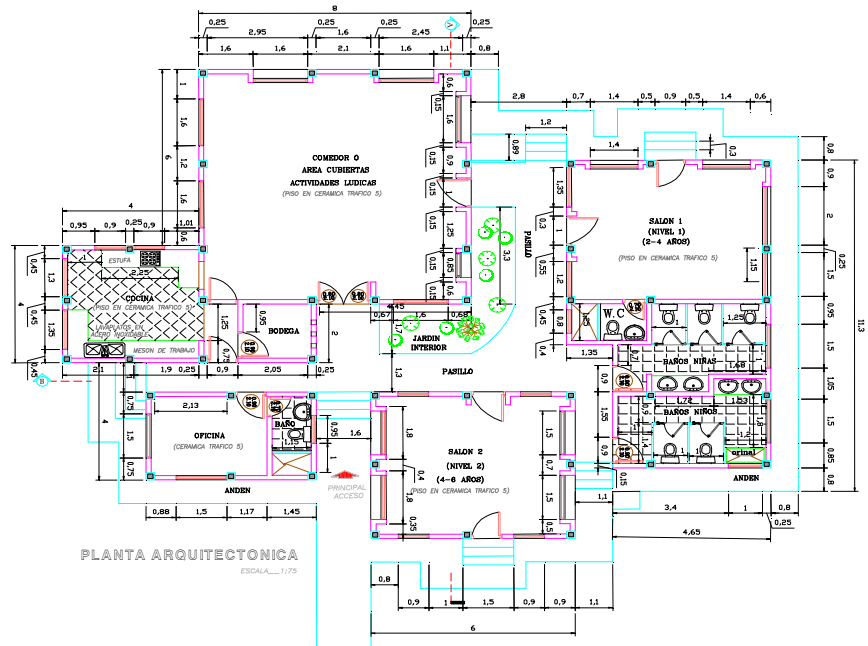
Planta Arquitectónica, Hogar Infantil Once de Noviembre.
